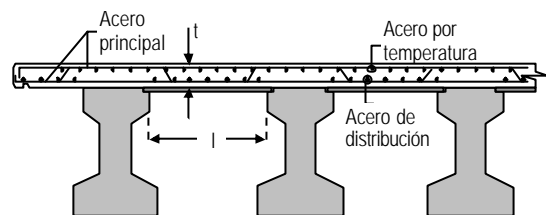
Sección transversal en una losa de concreto mostrando el acero de refuerzo
